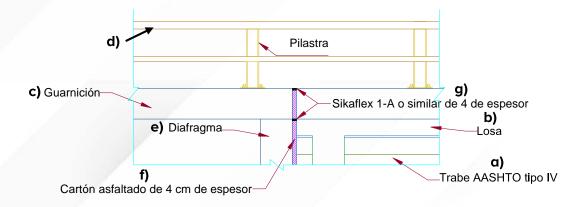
Ejemplo detalle de apoyos en caballetes y pilas
